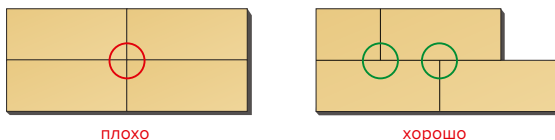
Укладка плит: а) без разбежки, б) с разбежкой швов
